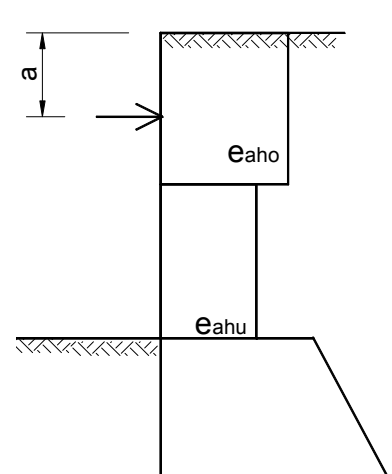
Erddruckumlagerung in Anlehnung an EB 70 der EAB bei einfach gestützten Wänden
